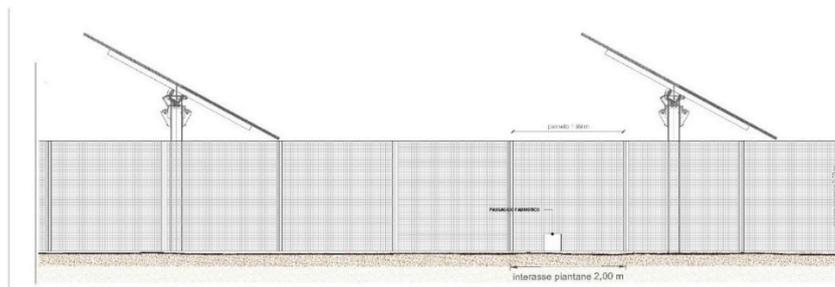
Prospetto recinzione perimetrale senza mitigazione
